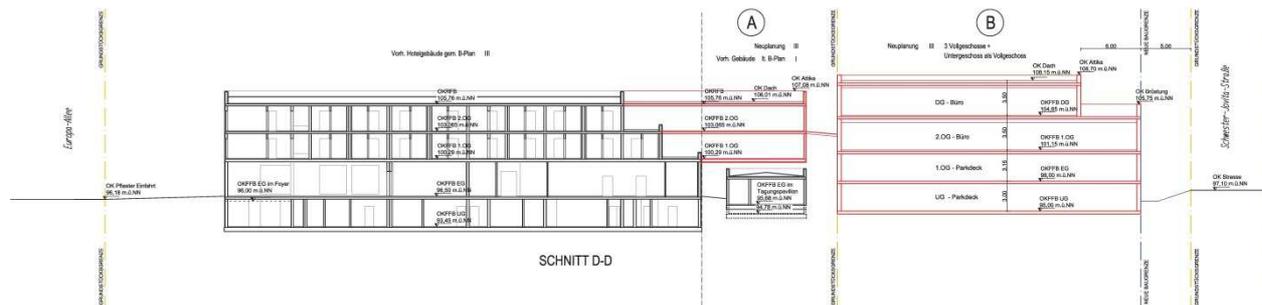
Gebäudeschnitt „West“ mit Höhenstaffelung zur Schwester-Jovita-Straße (rechts im Bild; unmaßstäblich)
